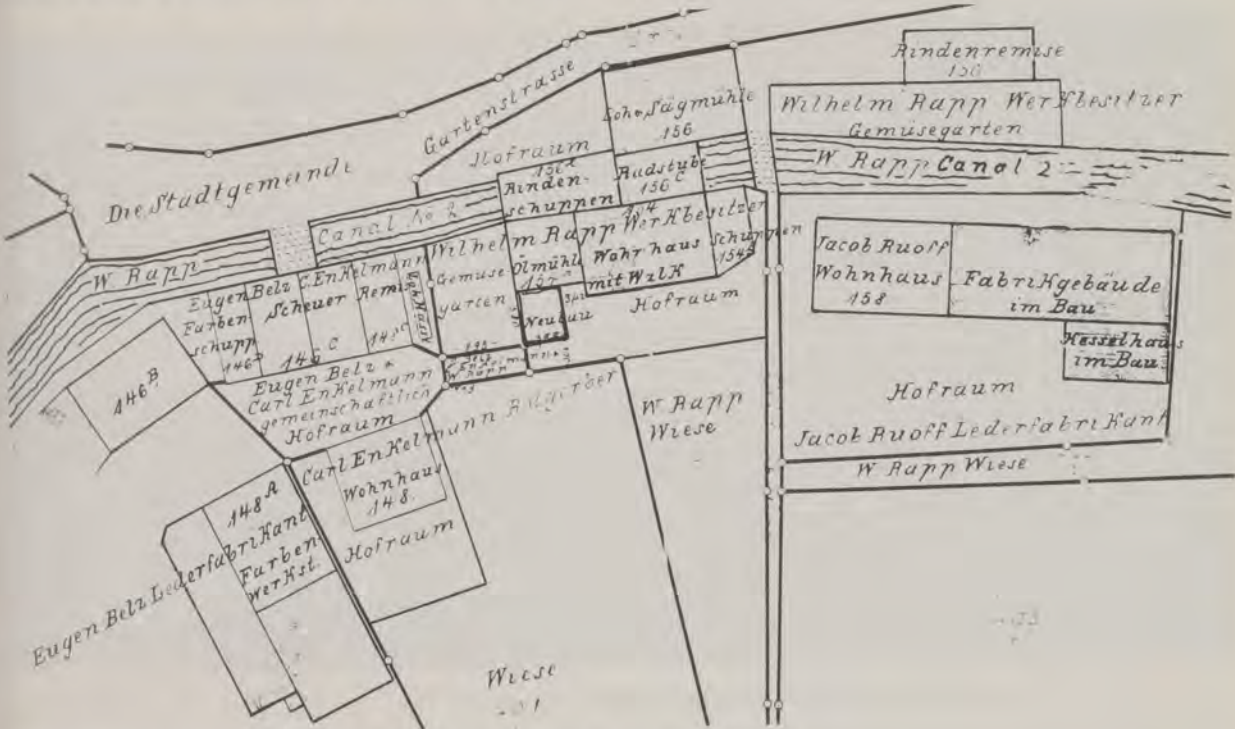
Lageplan vom Industriebereich „Walke“ im Jahr 1898.
